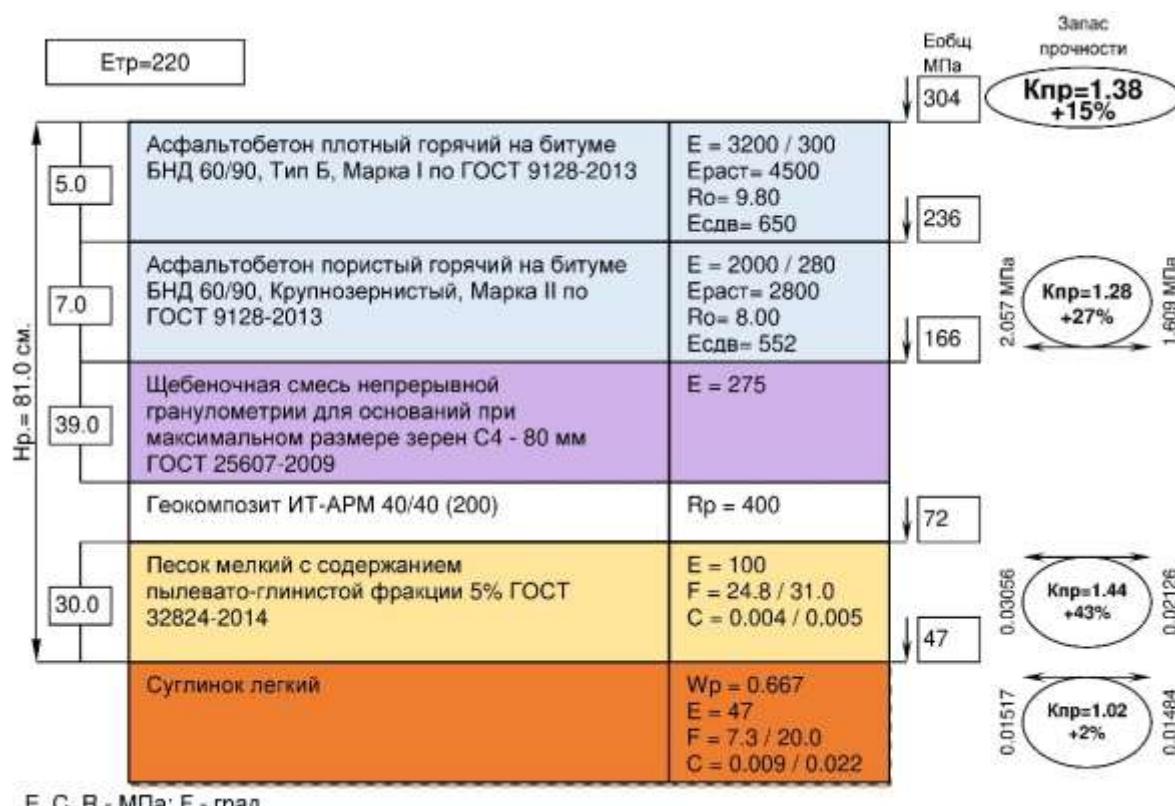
Конструкция дорожной одежды капитального типа без укрепления грунта
